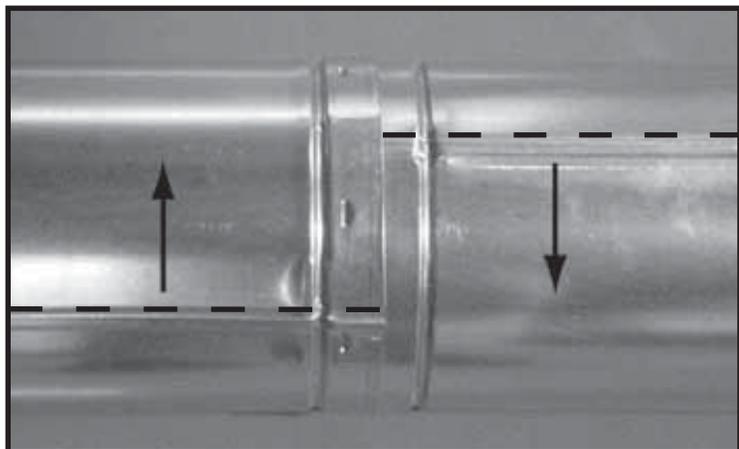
Faire pivoter les cordons de soudure pour démonter
